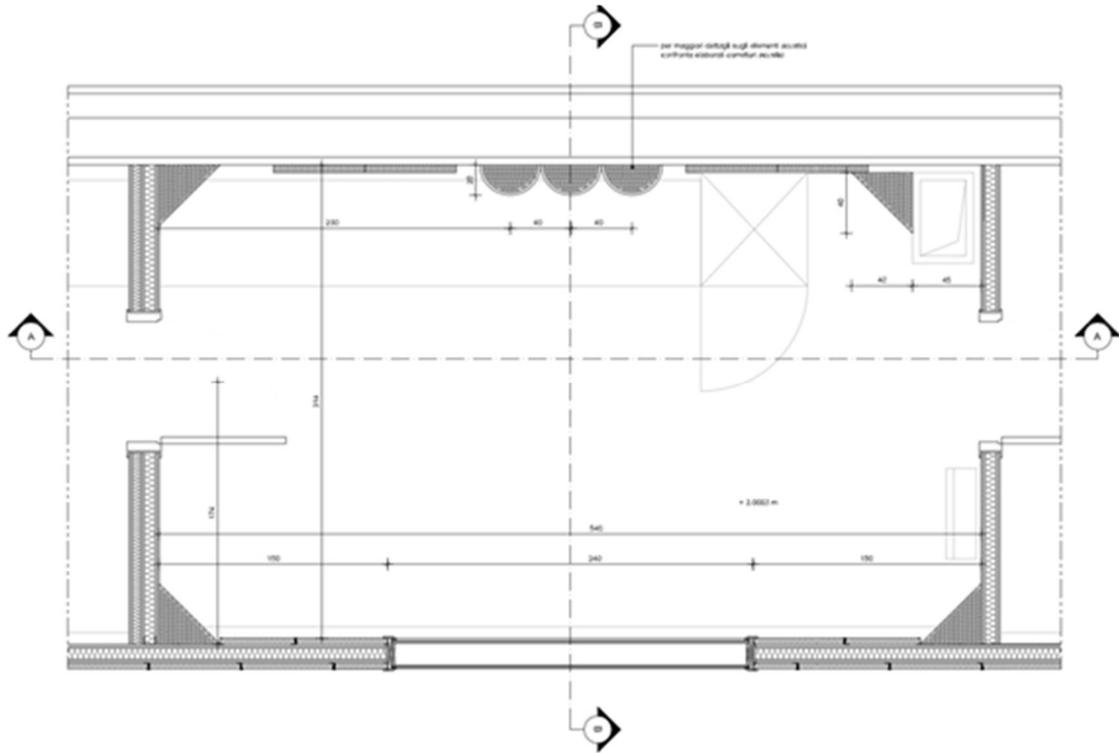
Sala regia - Planimetria e disposizione elementi per il condizionamento acustico
